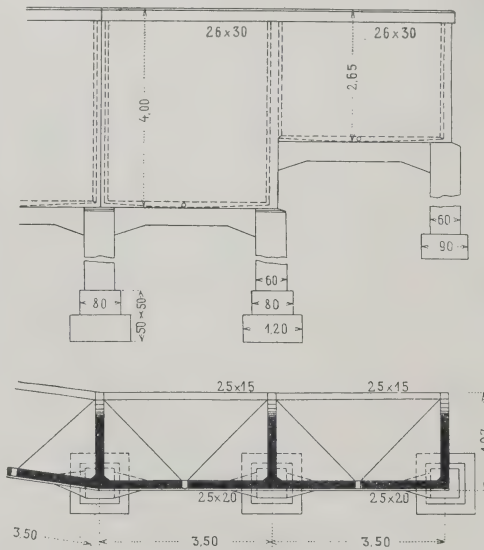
Grundriß und Ansicht der Stützmauer in Pullach.
